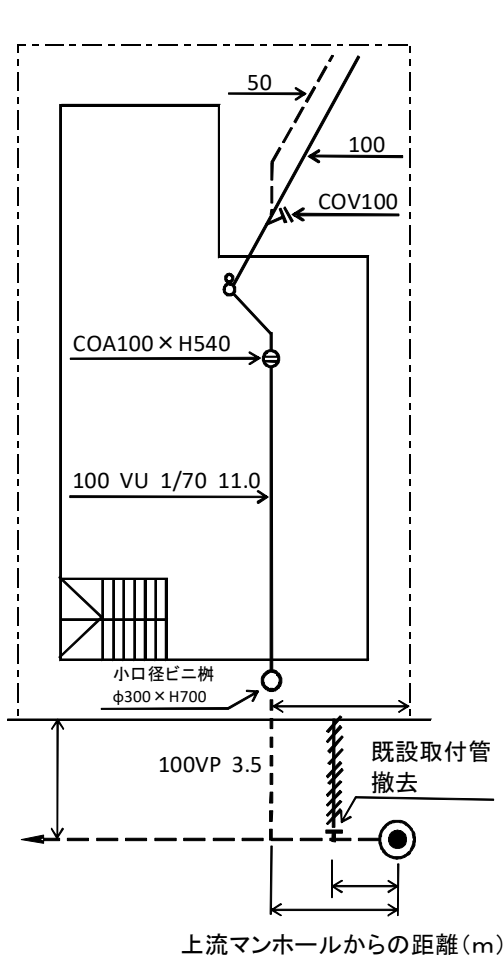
排水設備標準図 (例 2) 平面図縮尺 1/200
